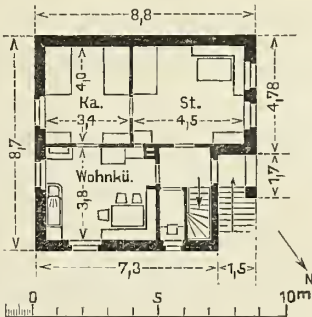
Grundriß zu Abb. 2. Einfamilienhaus.
